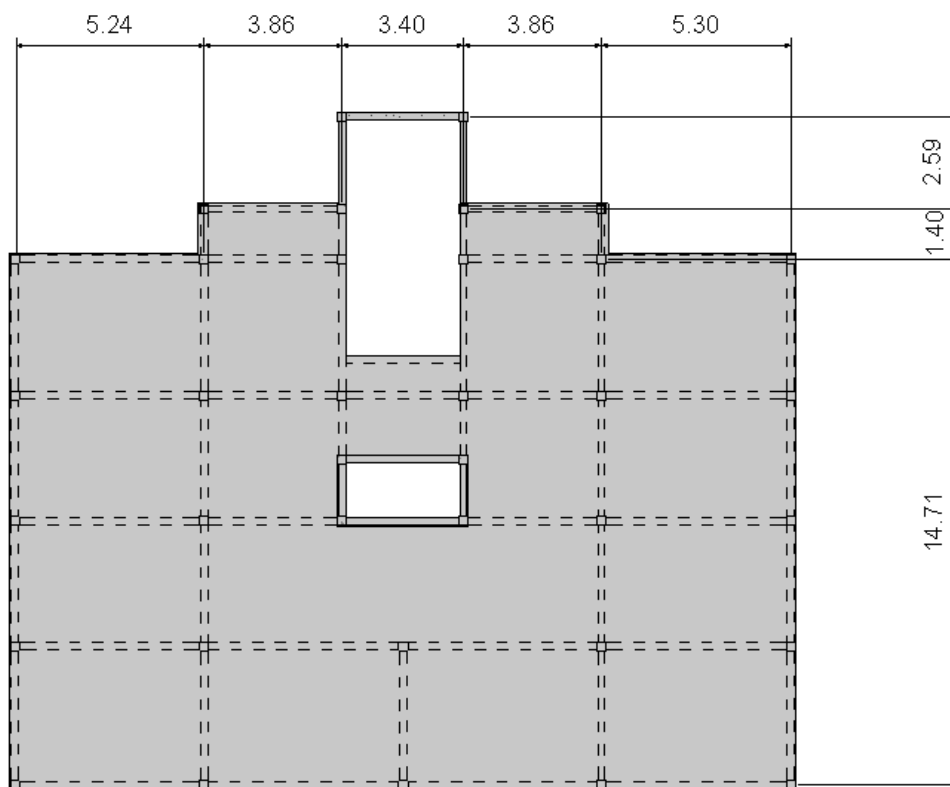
Planta estrutural do sótão da solução estrutural 2 (Revit).
